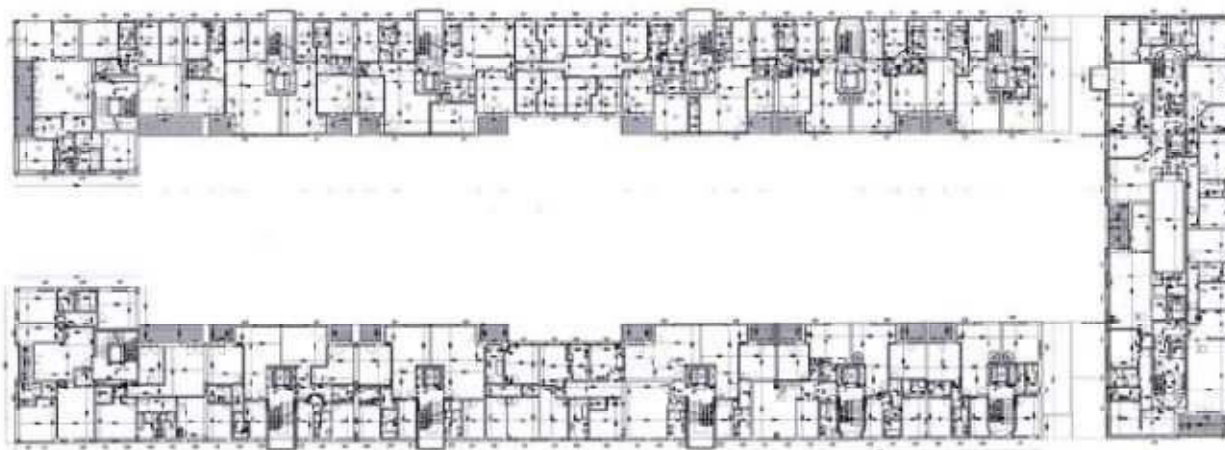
Pianta dell'edificio residenziale convenzionato alla Nuova Bicocca di Vittorio Gregotti
